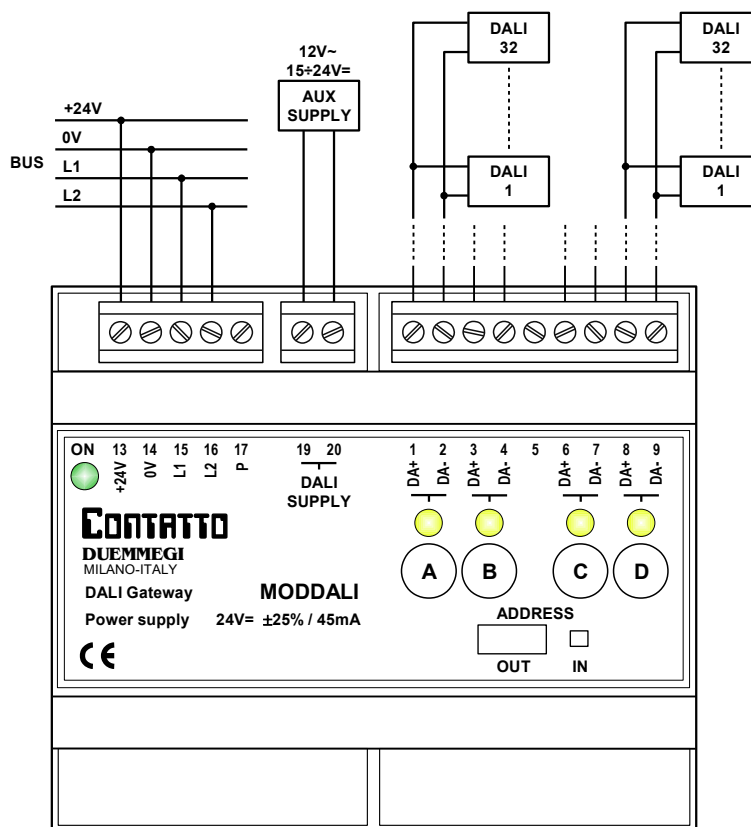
Schema di collegamento versione standard 4 linee 32 ballast
